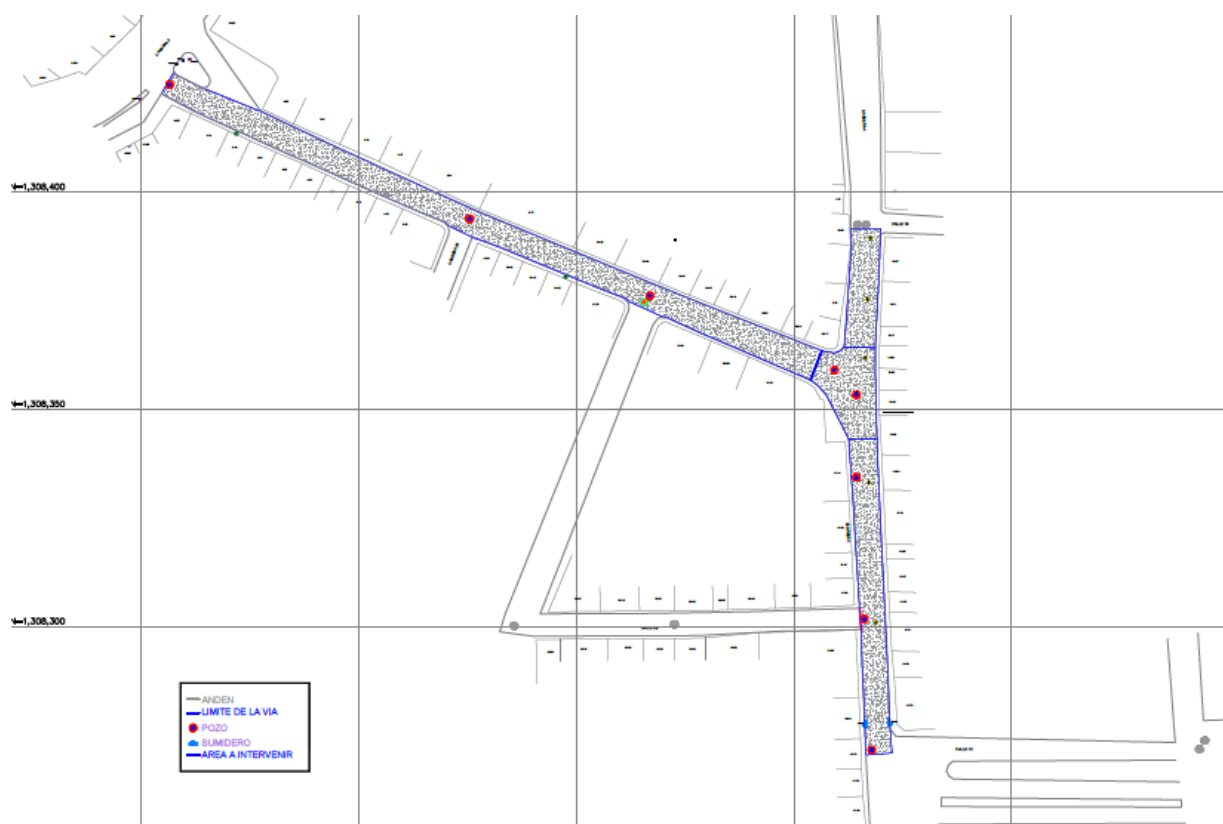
Área de pavimento rígido por la calle 1C y carrera 4
